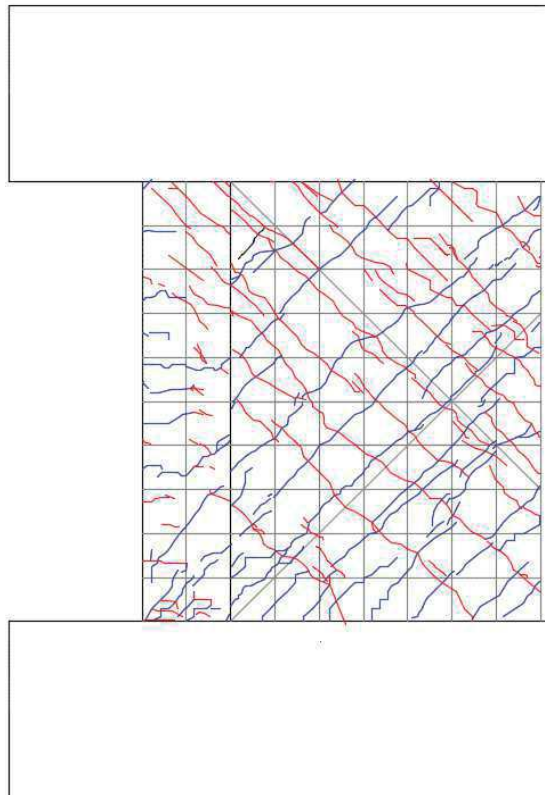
試験体 S-06-DIII 事前加力終了時 (4/1000rad.) ひび割れ図
